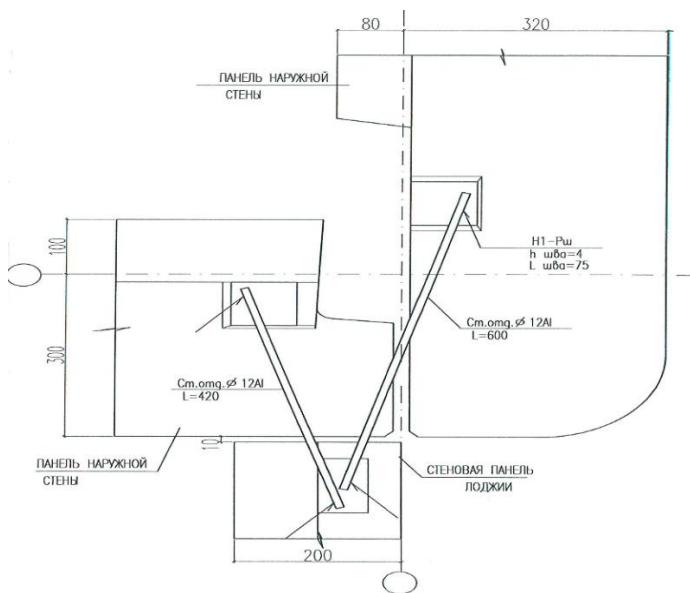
Устройства постоянного закрепления верхнего узла
